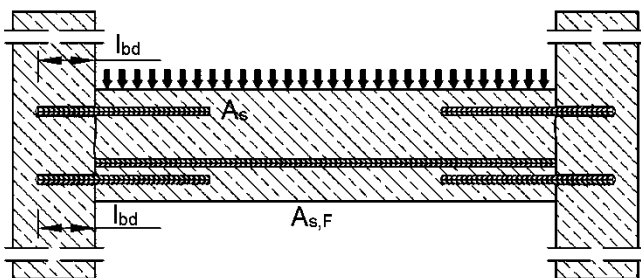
Bewehrungsanschlüsse überwiegend auf Druck beanspruchter Bauteile; Bewehrungsstäbe auf Druck beansprucht
